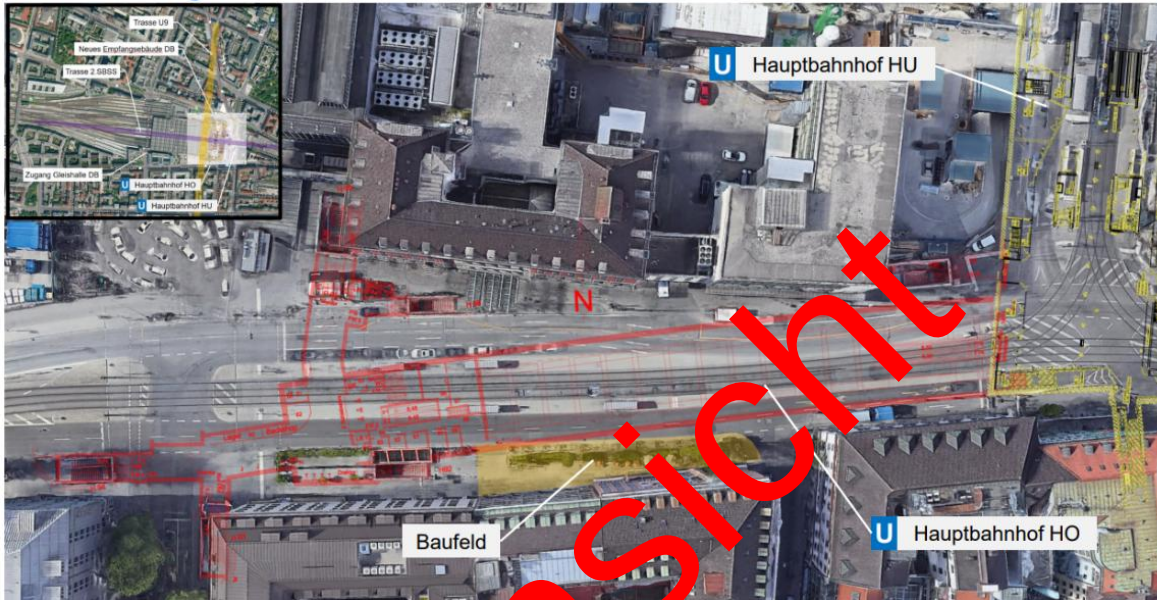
Lageplan U-Bahn-Station HO, Berliner Strasse. Quelle: Google Earth
